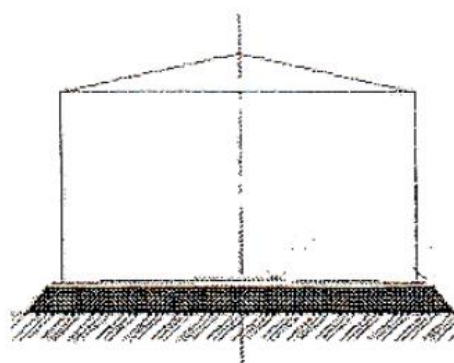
Теплоизолирующая подушка на свайном фундаменте [23]
